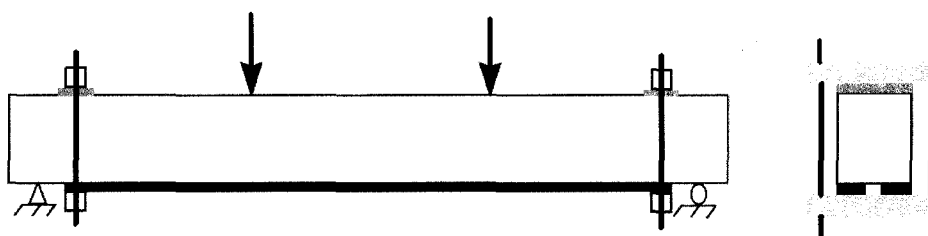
Renforcement d'ancrage par des serres – Poutre C (Buyle-Bodin et David 2004)
